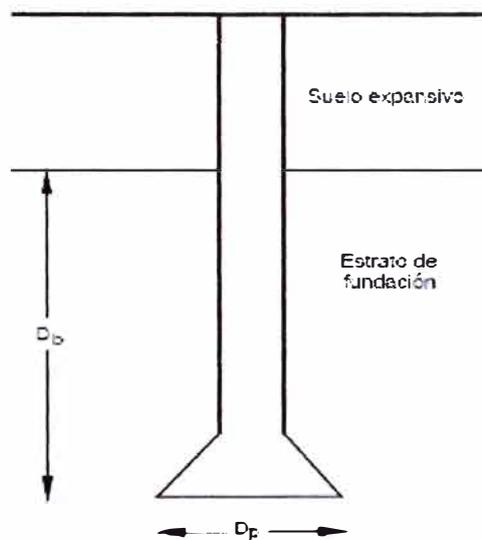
Levantamiento de un pilote excavado con base acampanadas
